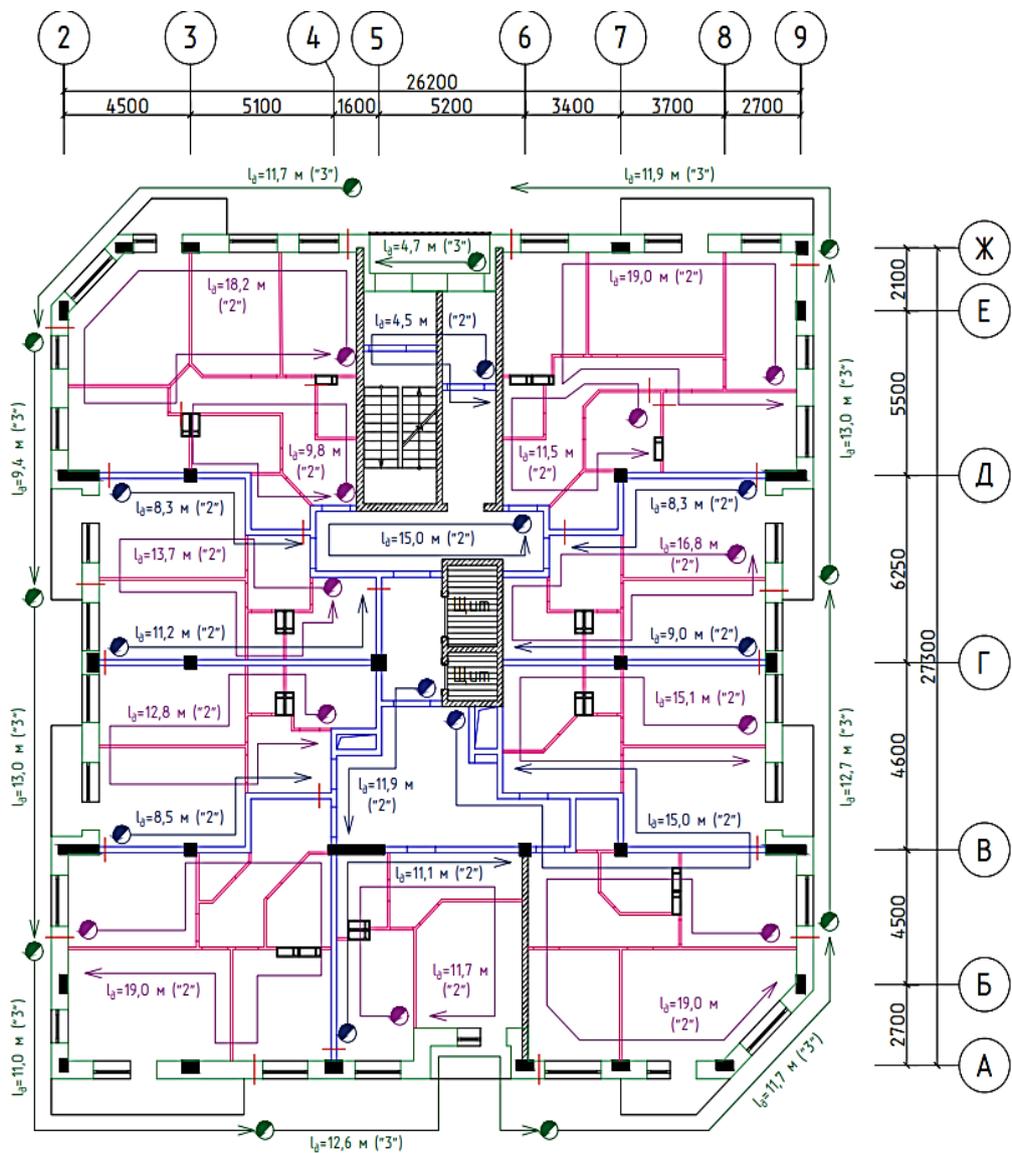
Схема границ дялянок при устройстве наружных стен типового этажа на отм. +3,600
